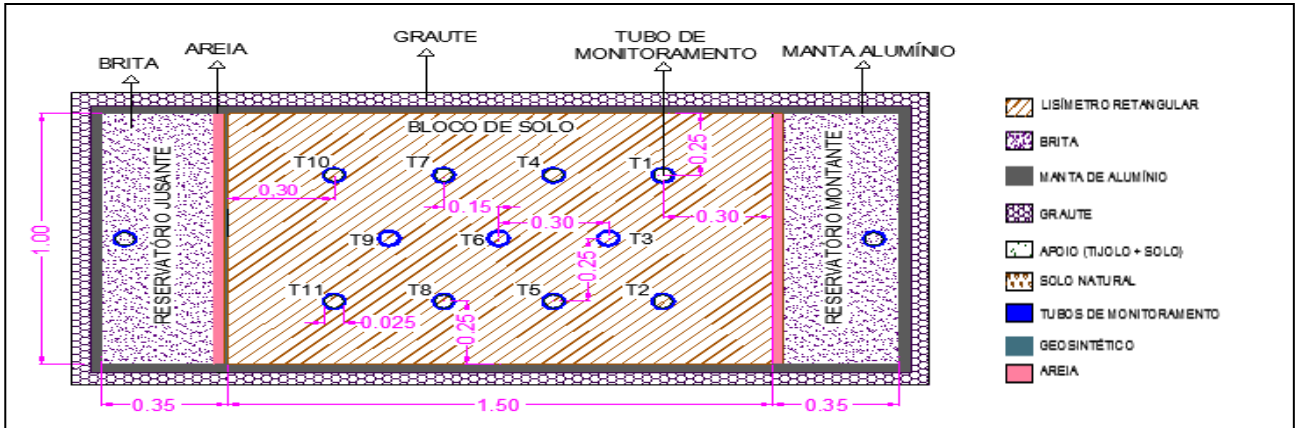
Vista em planta baixa das dimensões e posição dos tubos de monitoramento no bloco de solo.
